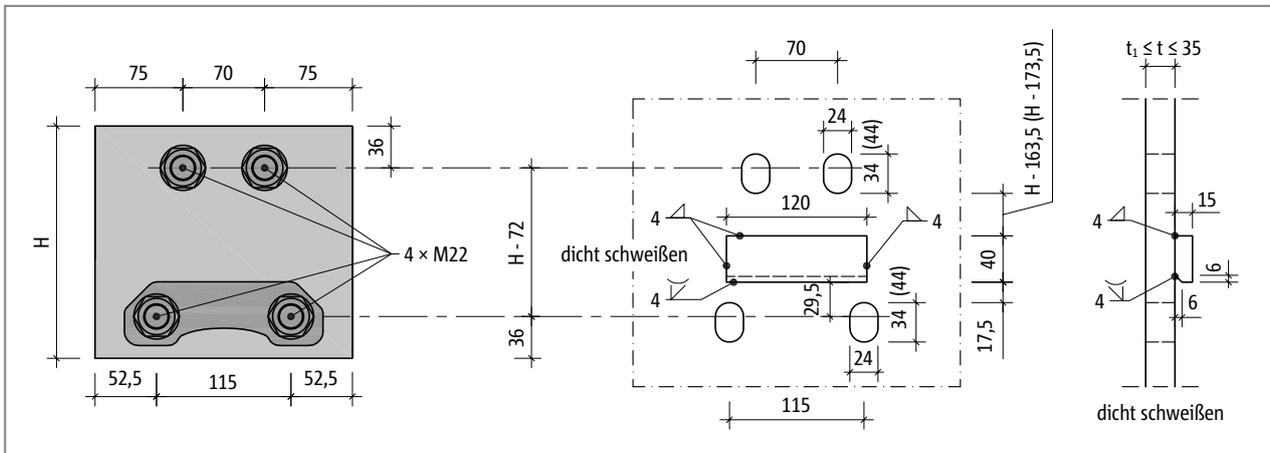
Schöck Isokorb® XT Typ SK-MM2: Konstruktion des Stirnplattenanschlusses
